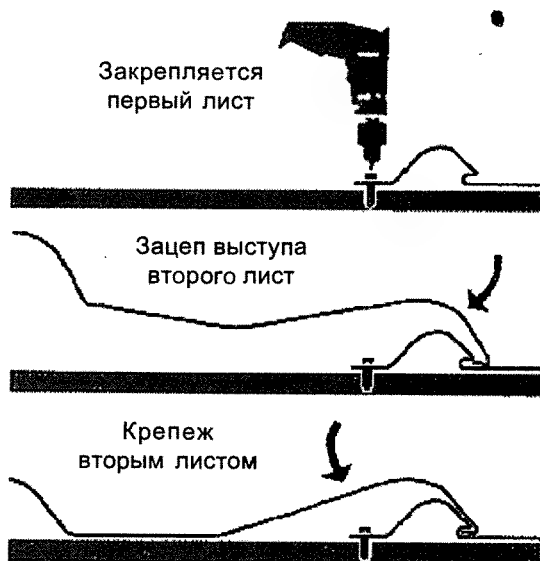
Монтаж металлочерепицы со скрытым креплением
